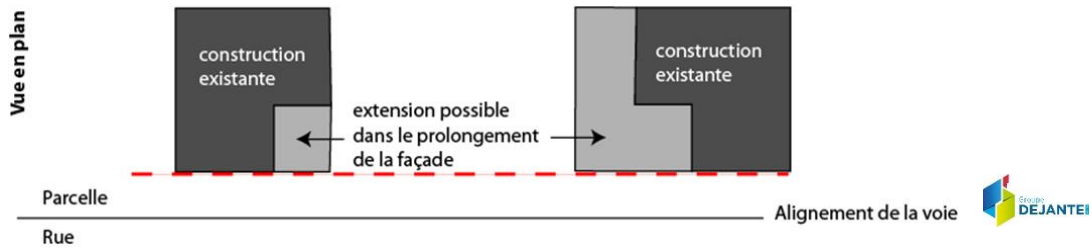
Implantation dans le prolongement de la façade pour les extensions des constructions en zone Ua
